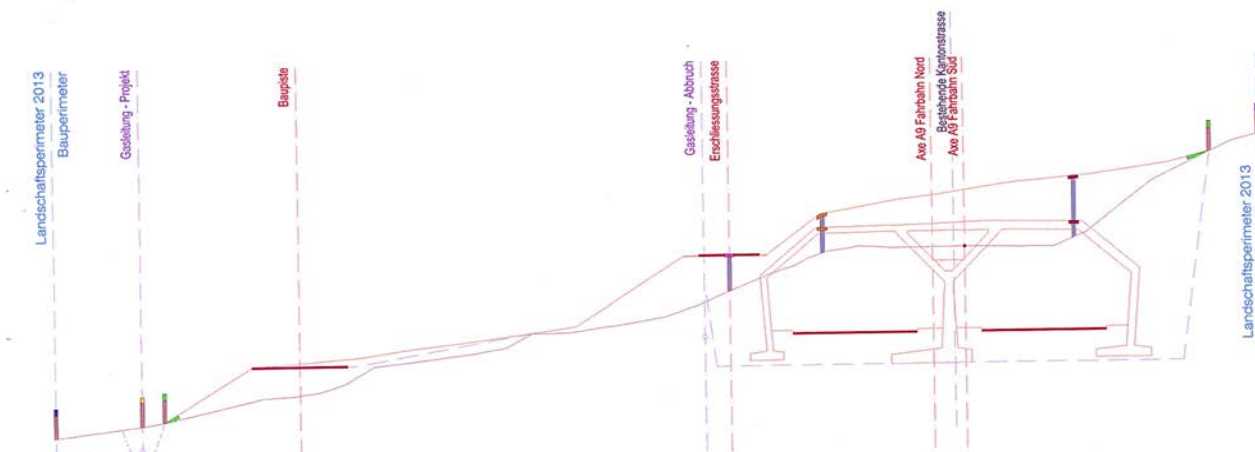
Querprofil Gedeckter Einschnitt Pfyn. Der Tagbautunnel schmiegt sich an den Gorwetschhang.
